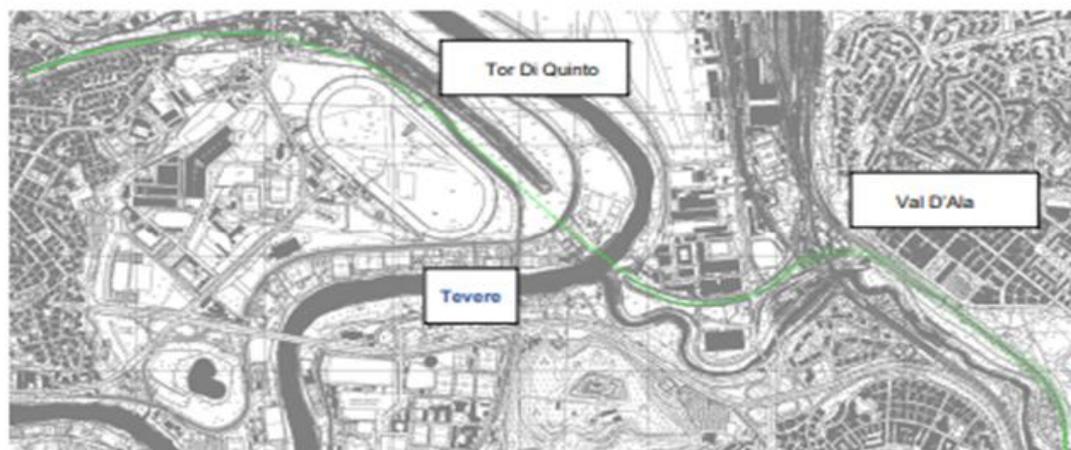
Planimetria e profilo soluzione totalmente in sotterraneo
